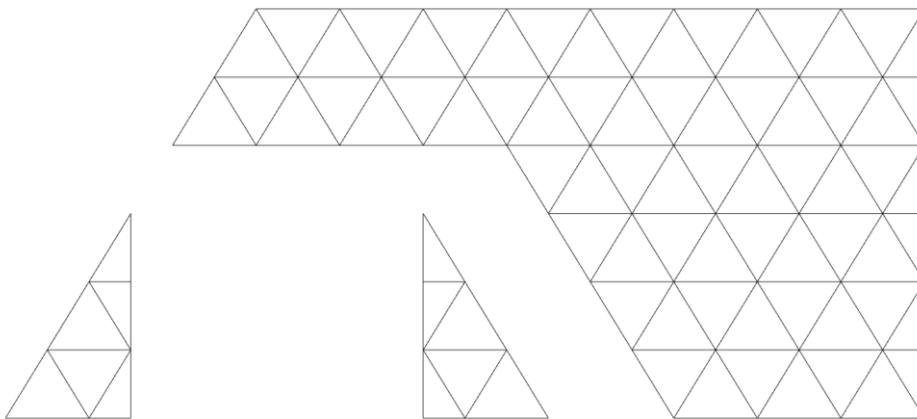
Estructura Interna, Malla 2, Muro Acristalado, Fase 1
